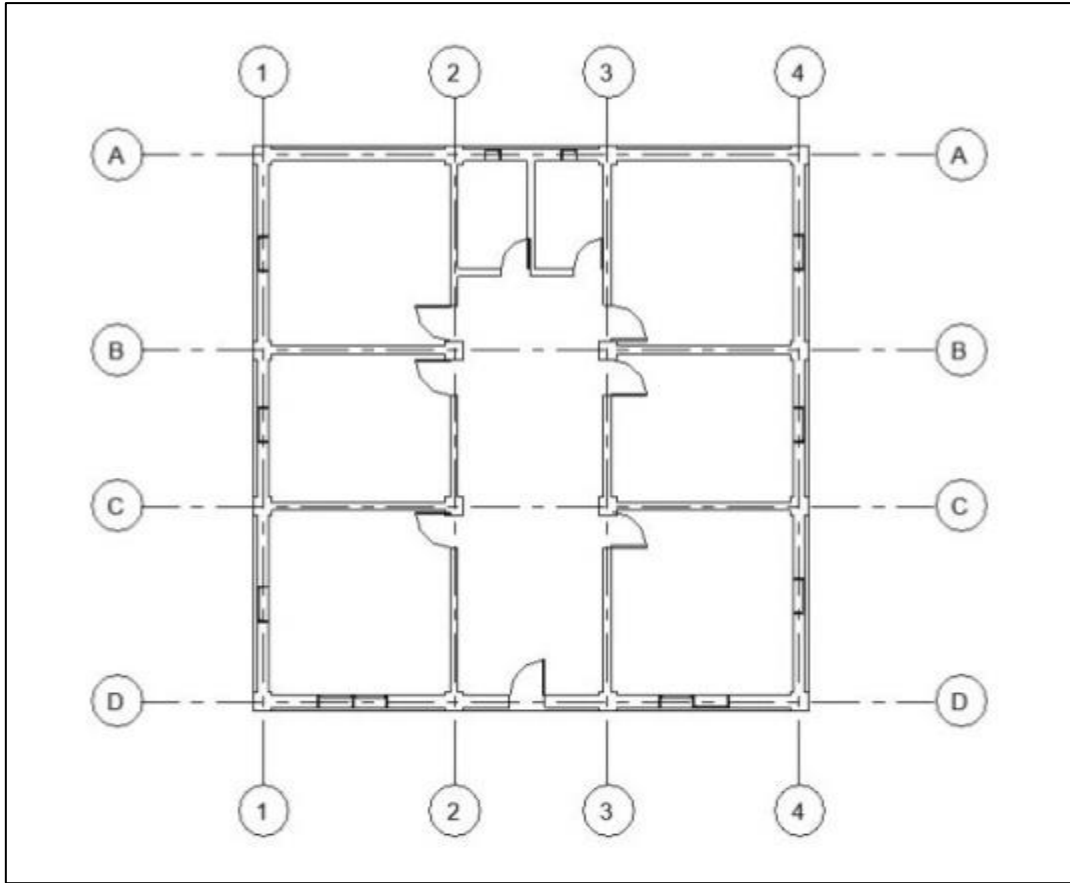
CAD ortamında 2B bina plan gösterimi
